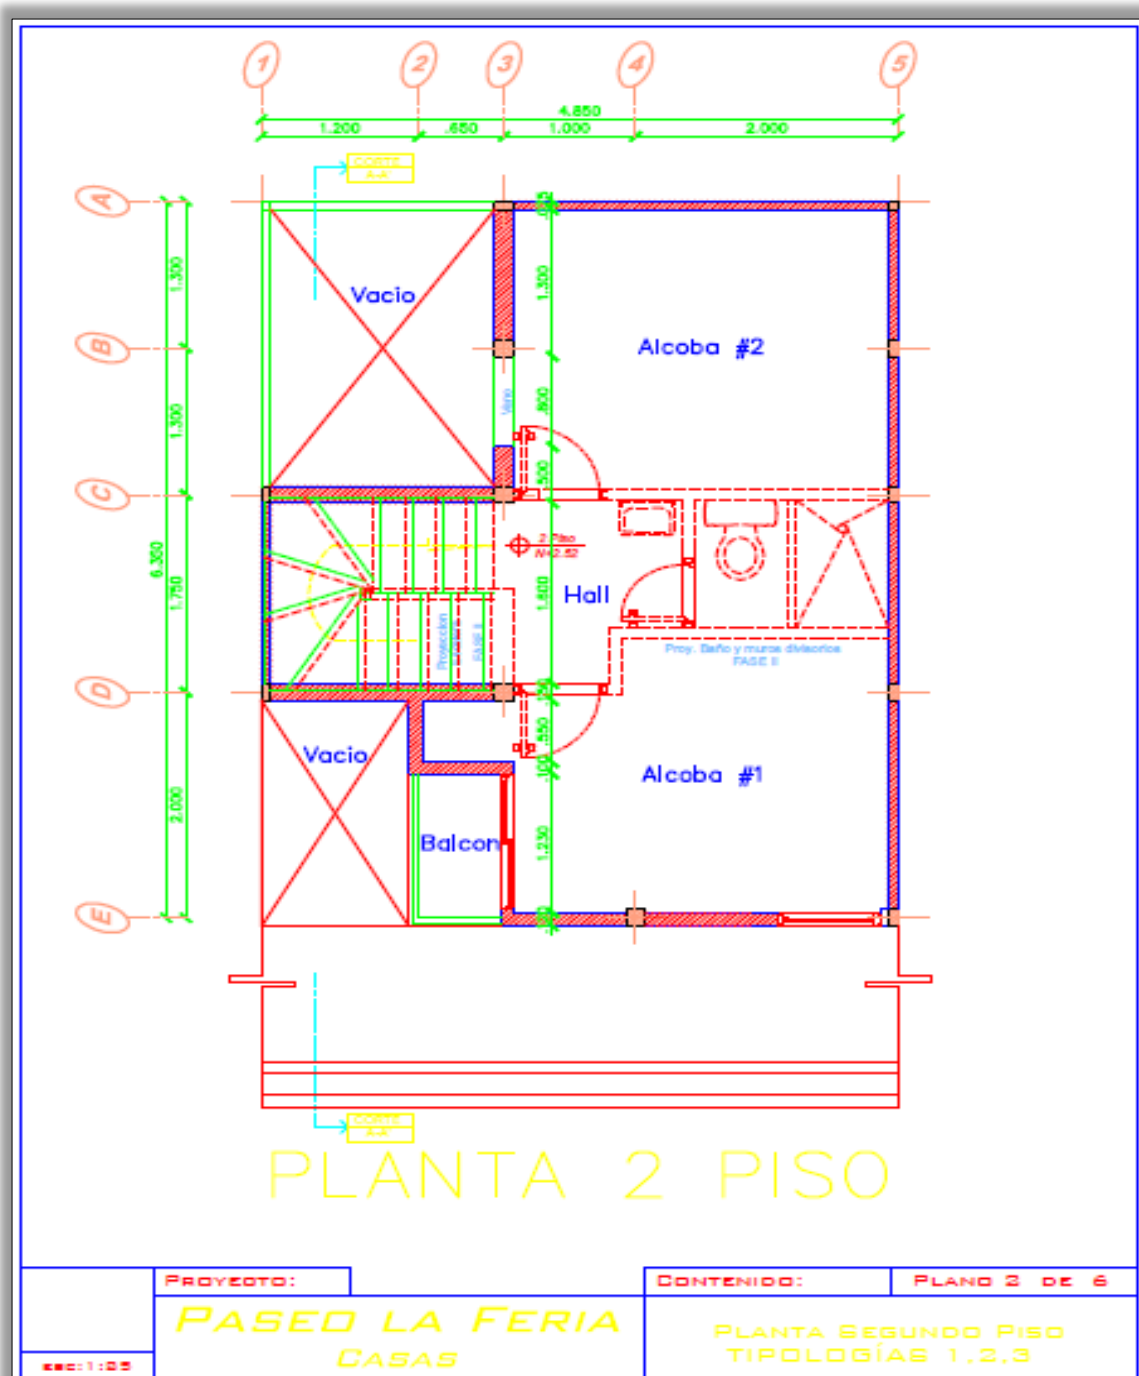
Plano segunda planta: vivienda tipo seleccionada [20]
